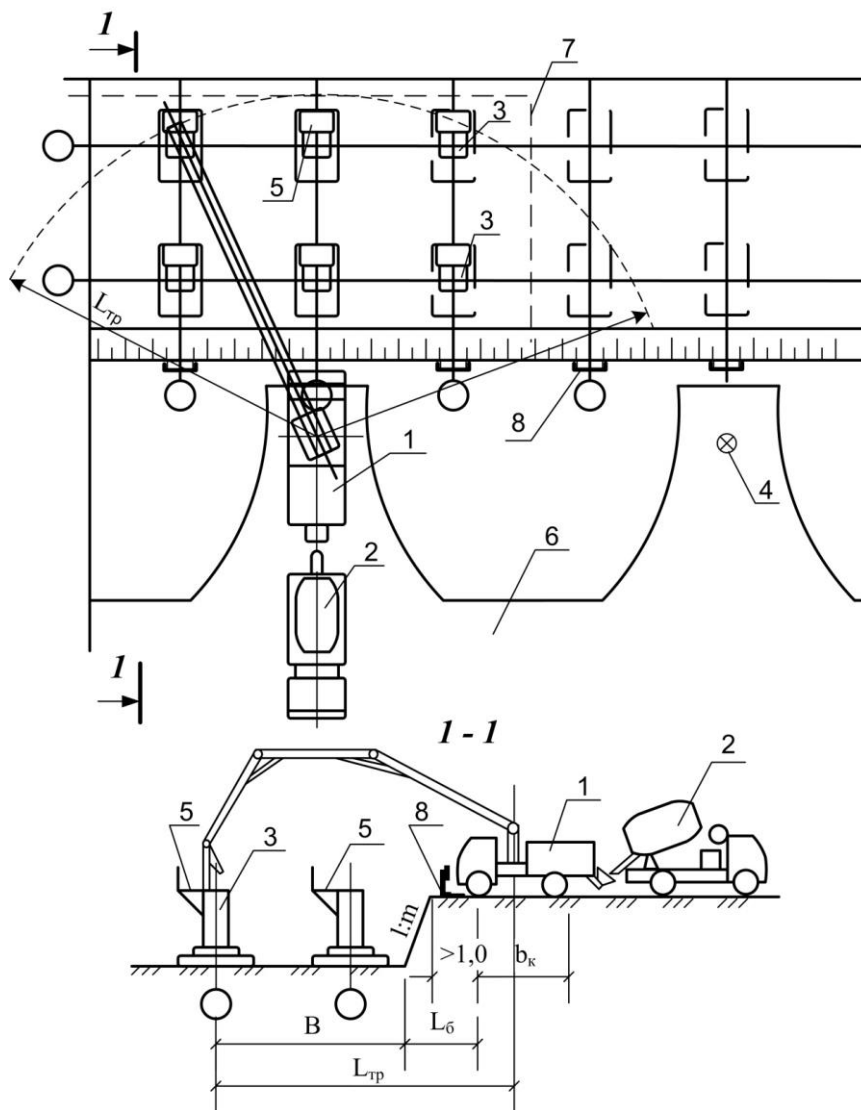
Технологическая схема бетонирования фундаментов при помощи автобетононасоса с бермы котлована:
